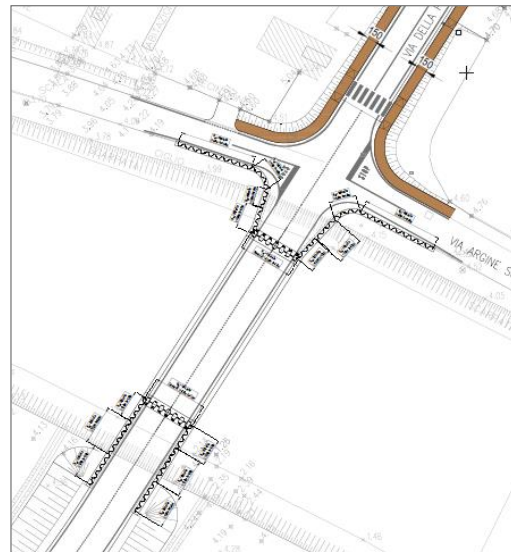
Planimetria ponte provvisorio da convertire nella passerella di accesso all'isola
